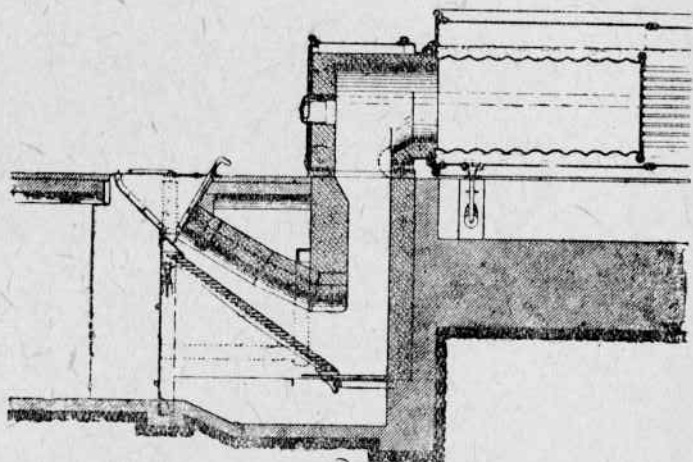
Подвальная топка со ступенчатой колосниковой решеткой для низкосортного топлива.
